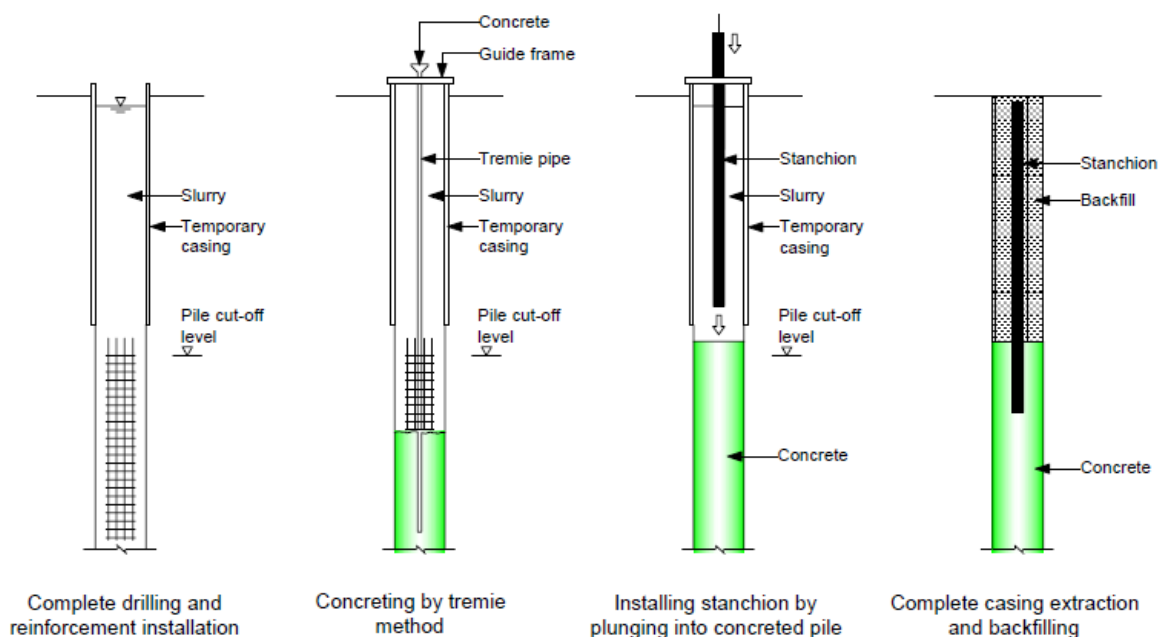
Proceso constructivo post hormigonado. Balasubramaniam et Al. (2000)
